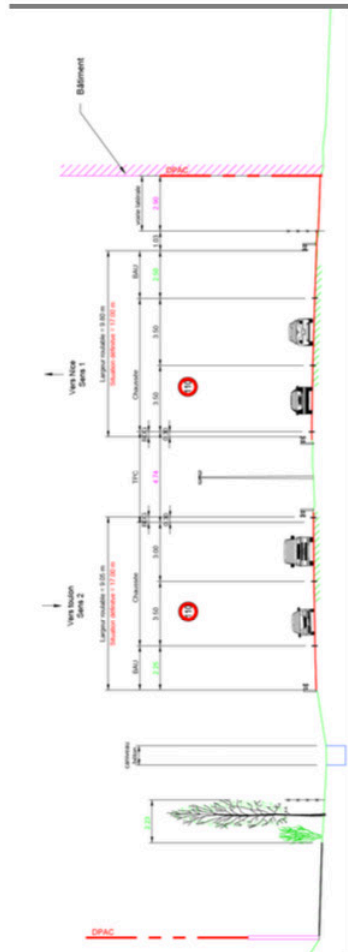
Profil en travers de l'A57 entre Tombadou et Les Fourches
